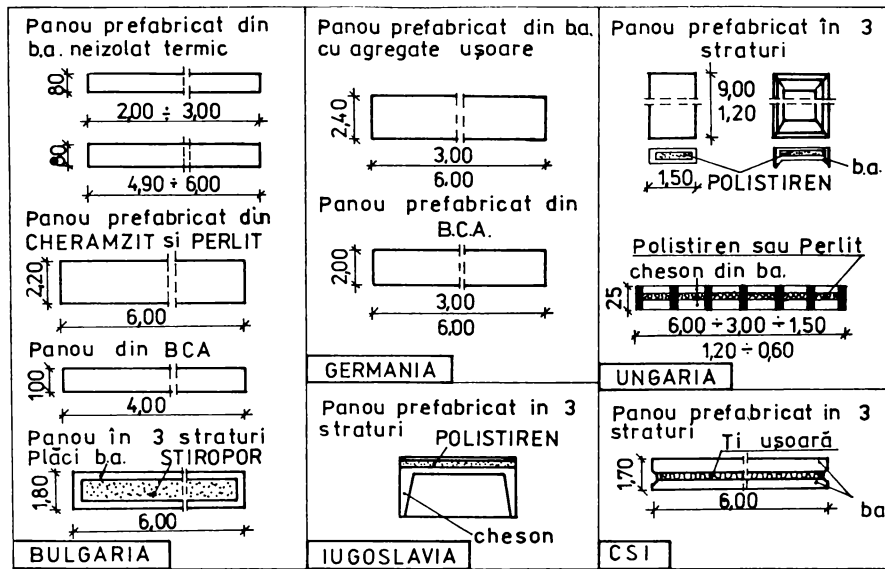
ELEMENTE DE PERETI DIN BETON
